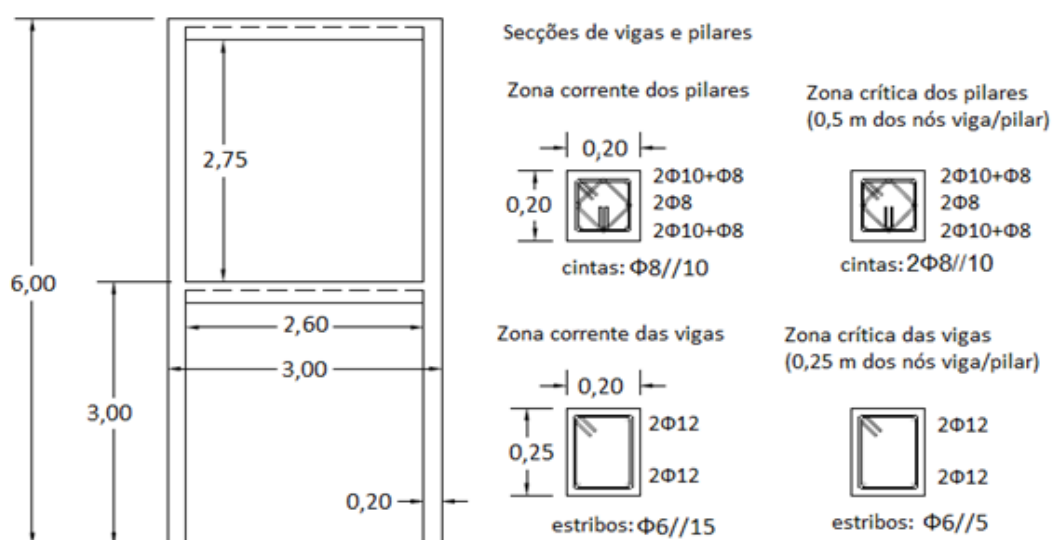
Geometria e disposição das armaduras de cada estrutura
